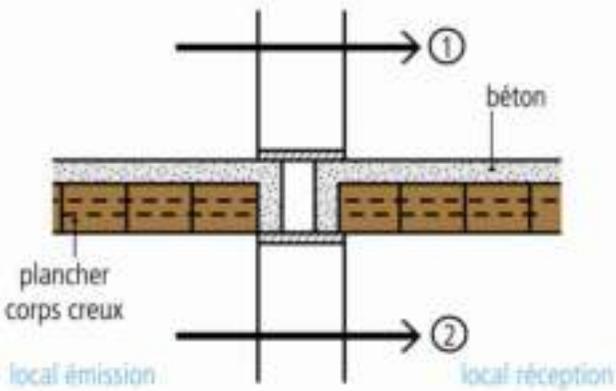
Plancher corps creux si les poutrelles sont perpendiculaires au séparatif.
